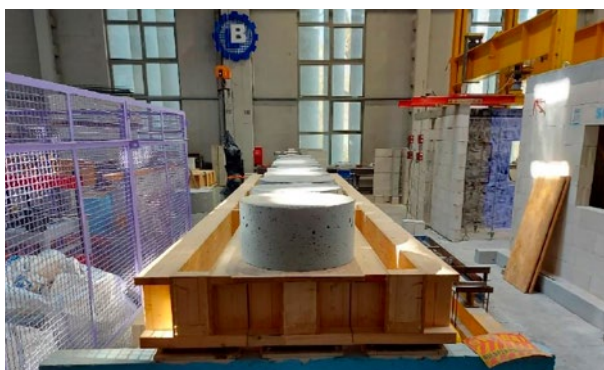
Hybrydowa belka stropowa w konstrukcji o rozpiętości 8 m
